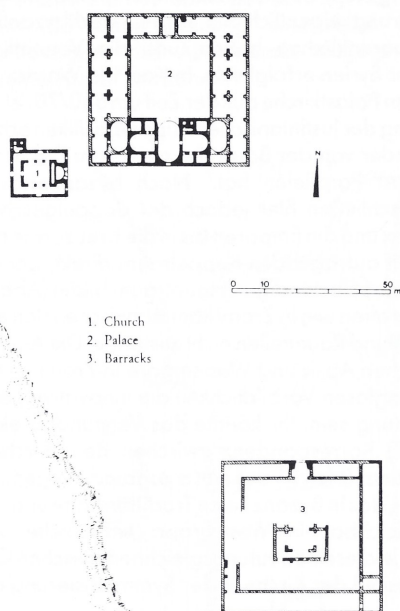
Kasr ibn Wardan, Palastkirche, Lageplan
